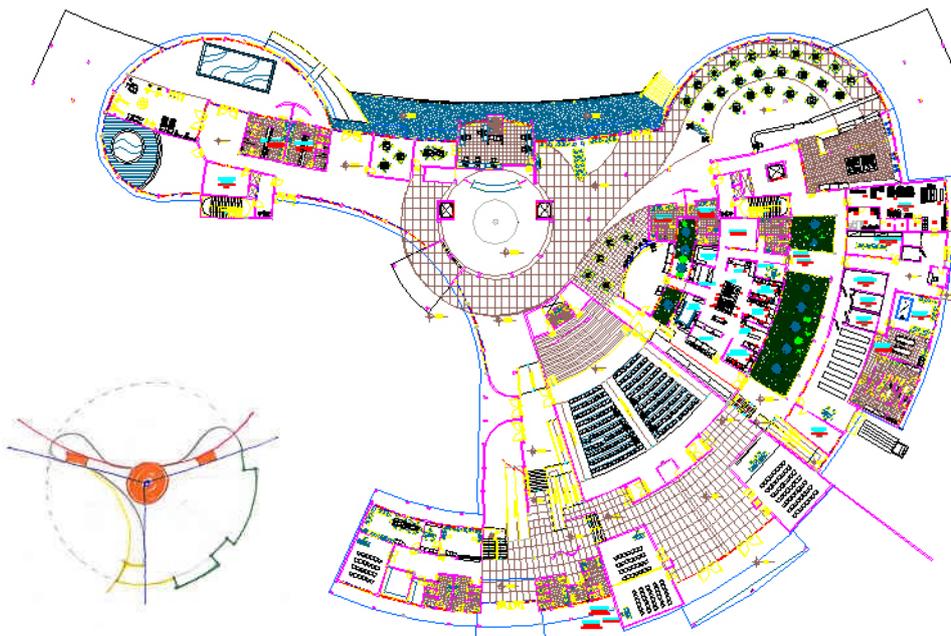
Planta Baixa Mobiliada Pav. Térreo, sem escala.
